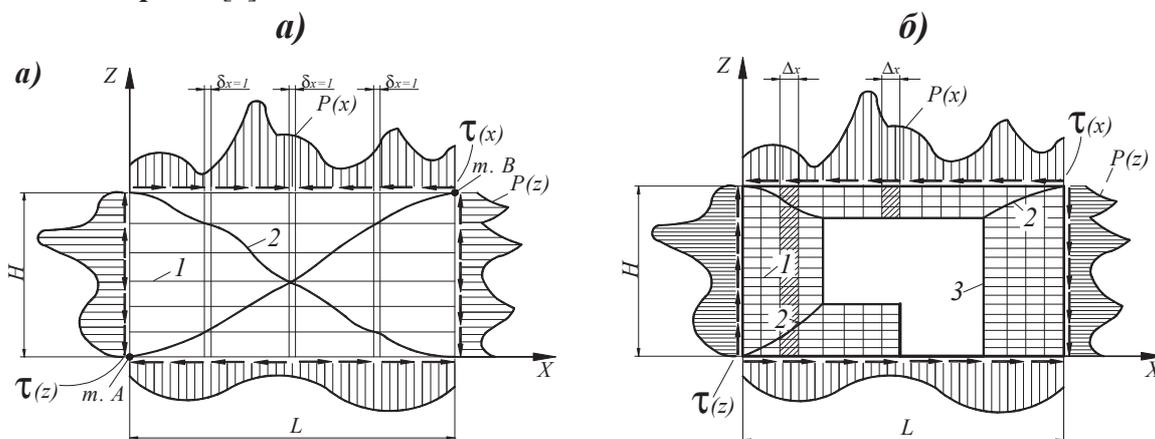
К расчету плосконапряженных железобетонных конструкций без отверстий (а) и с оконными и дверными проемами (б) на статические и сейсмические воздействия: 1 – границы конечных элементов; 2 – трещины; 3 – проем
